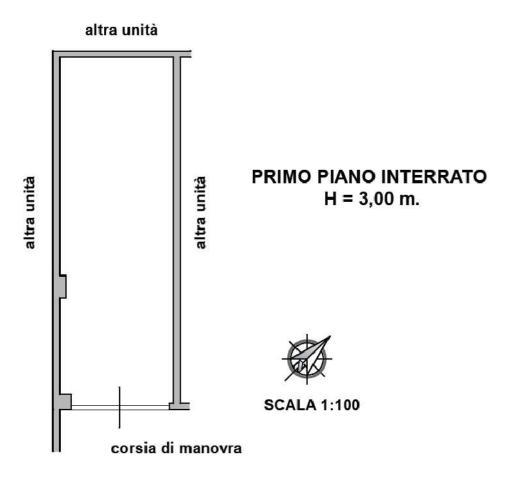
LOTTO 7 – Planimetria box auto foglio 76 – part. 620 – sub. 134
